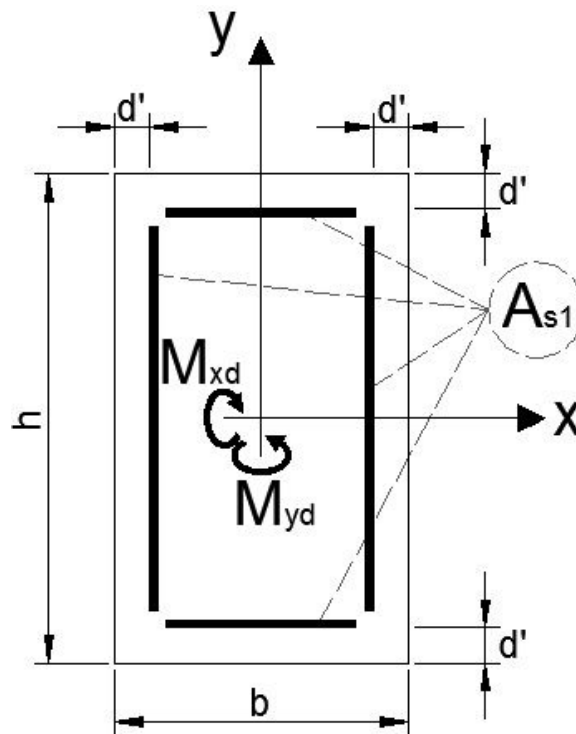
Esquema de sección de pilar para cálculo de dimensionamiento.
